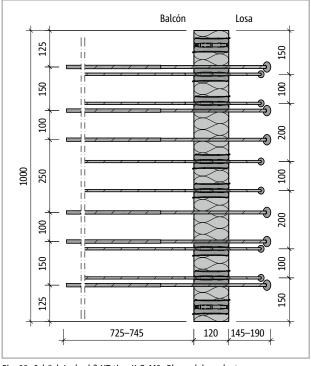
Schöck Isokorb® XT tipo K-O-M2: Plano del producto
